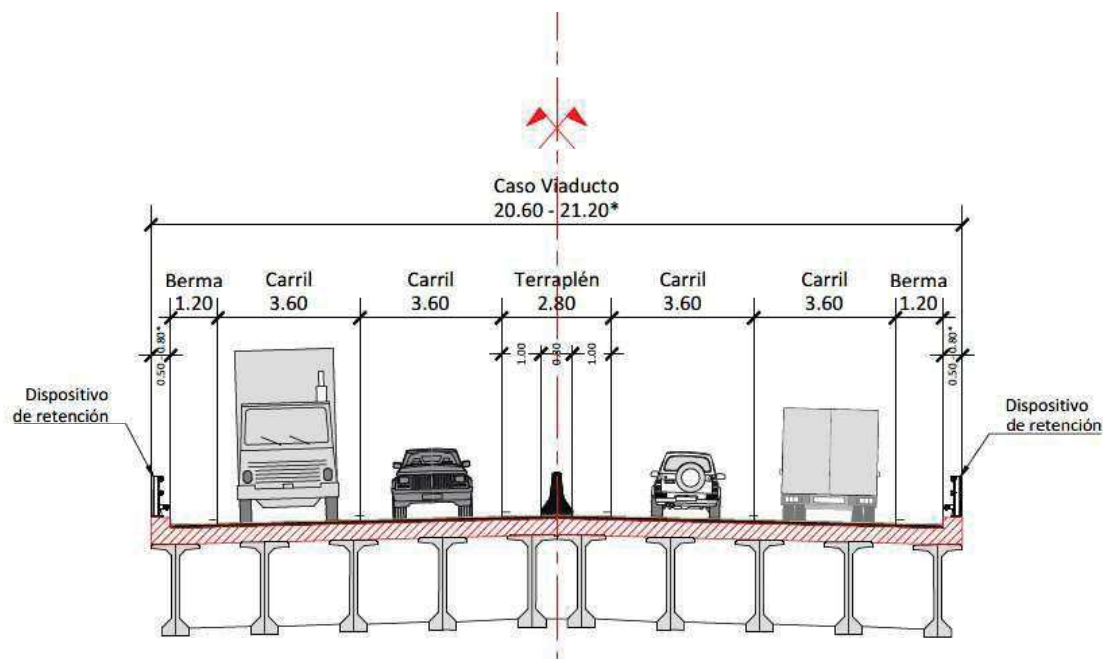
Sección transversal – Caso viaducto bidireccional con berma 1,20 m
